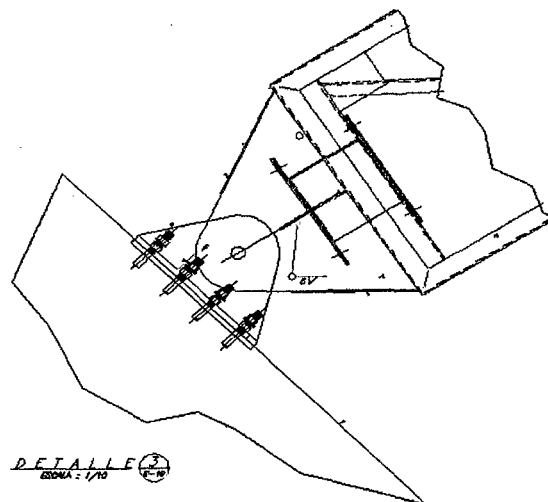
Esquema del apoyo colocado sobre la armadura, a la vez este transmite carga a los dados de concreto.
